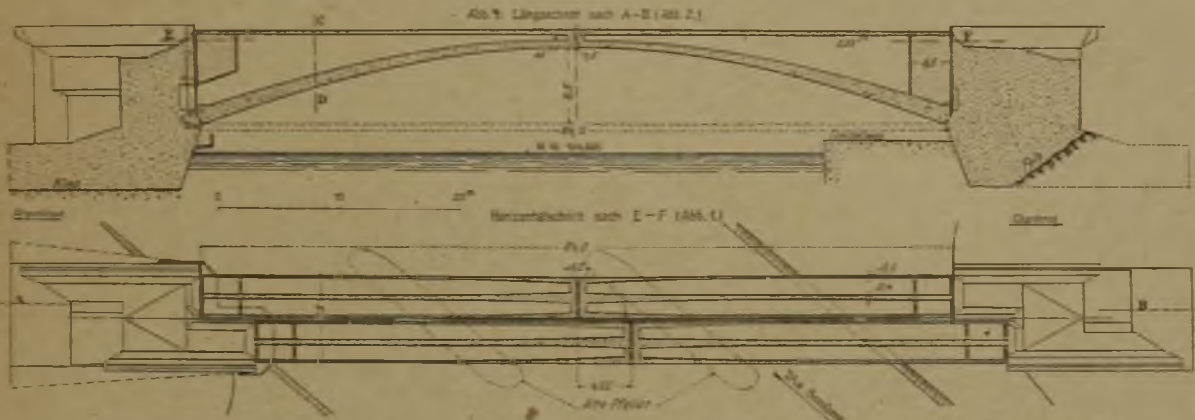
u. 2. Längsschnitt und Horizontalschnitt durch das Brückenbauwerk.
